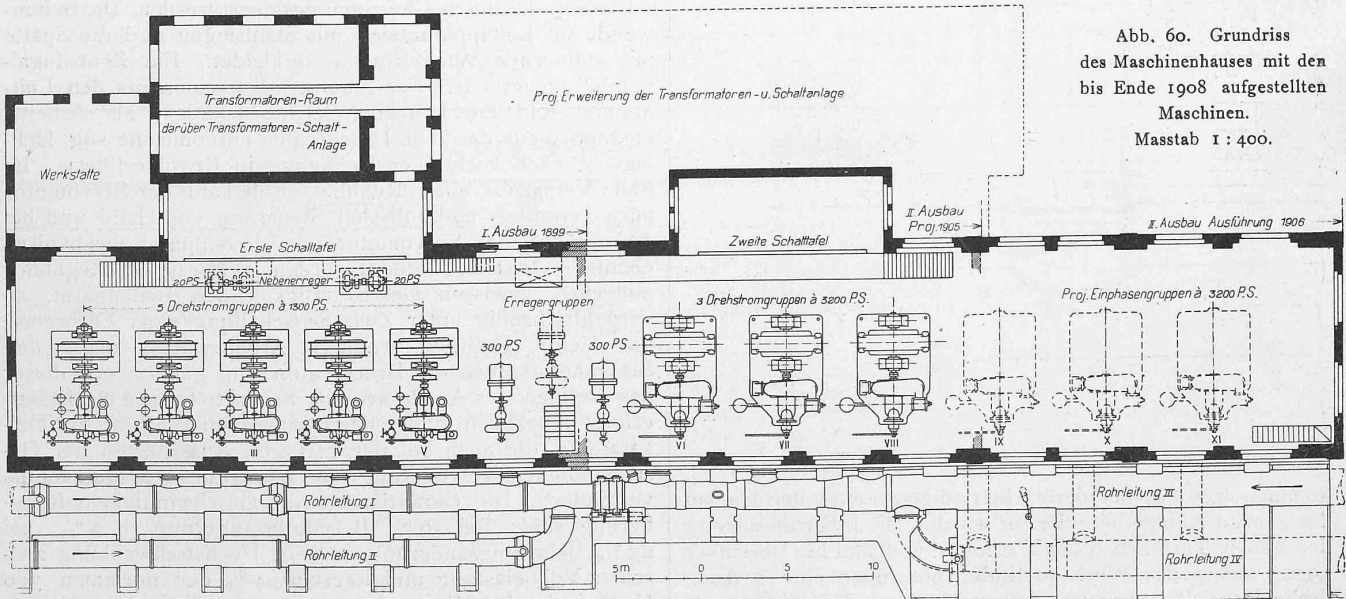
Grundriss des Maschinenhauses mit den bis Ende 1908 aufgestellten Maschinen. Masstab 1 : 400.
